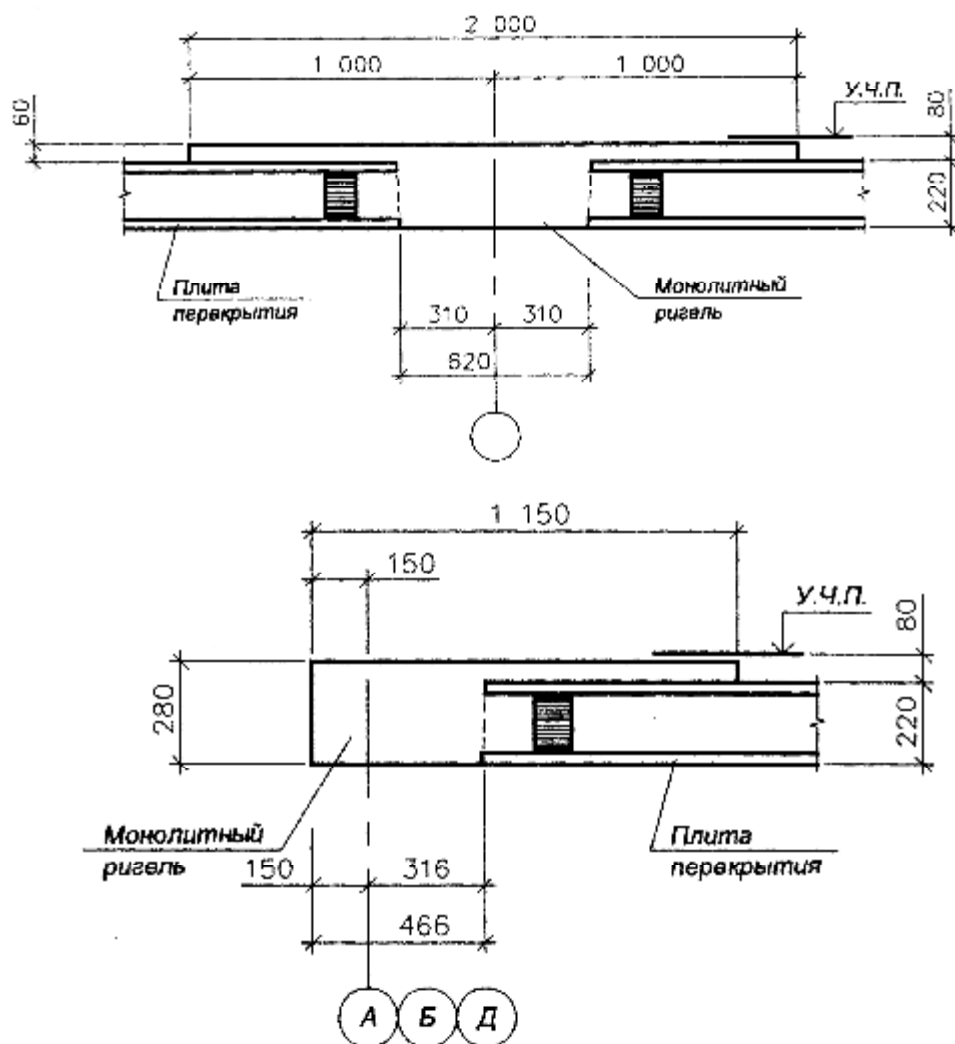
Стык плит перекрытия с рядовым и крайним ригелем соответственно (размеры условные)
